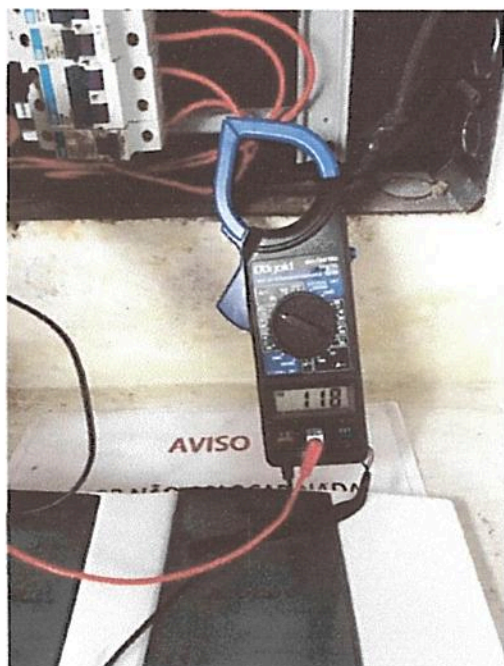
medição da Tensão de entrada entre Fase e Neutro
